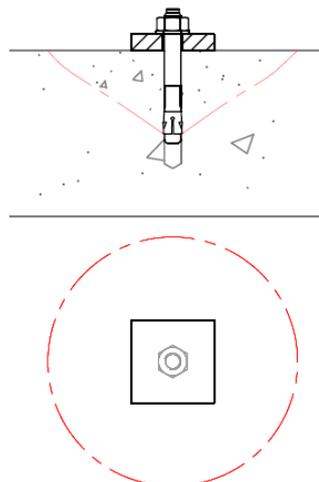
Zone d'influence d'une cheville isolée en pleine dalle
